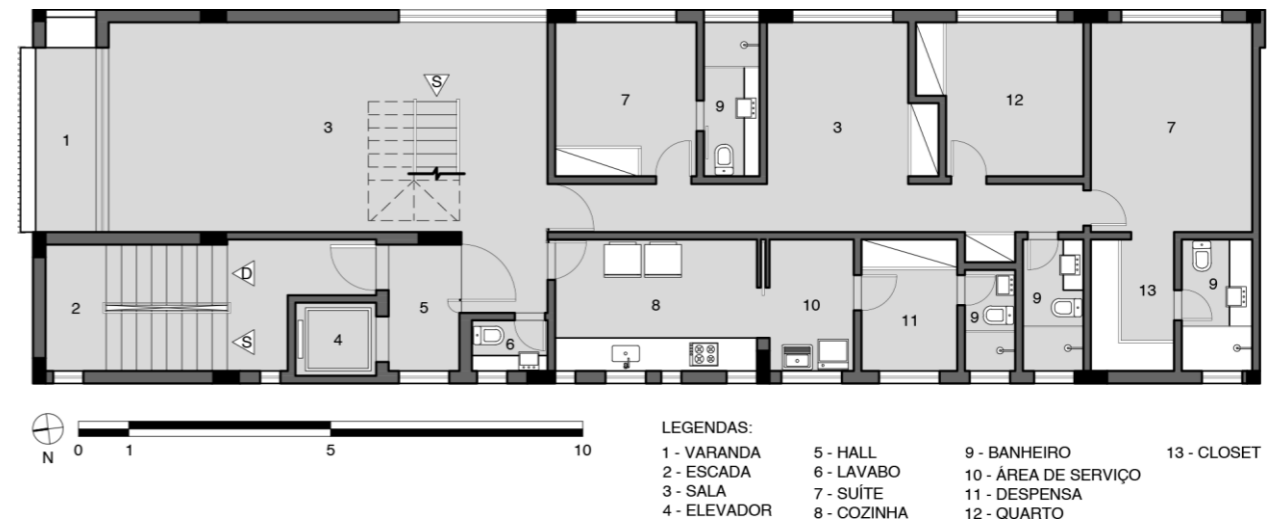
Planta do quinto pavimento do Residencial Flor de Liz
